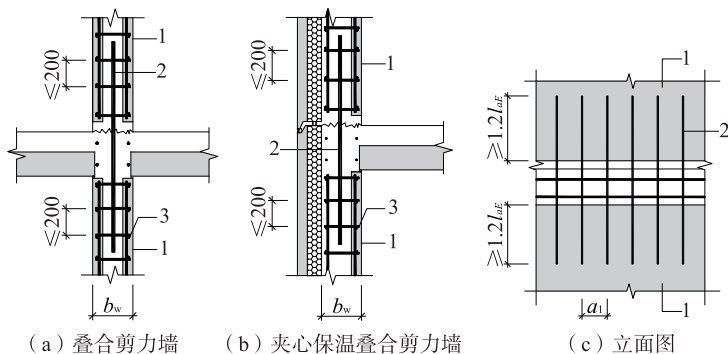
叠合剪力墙竖向分布钢筋单排连接构造
